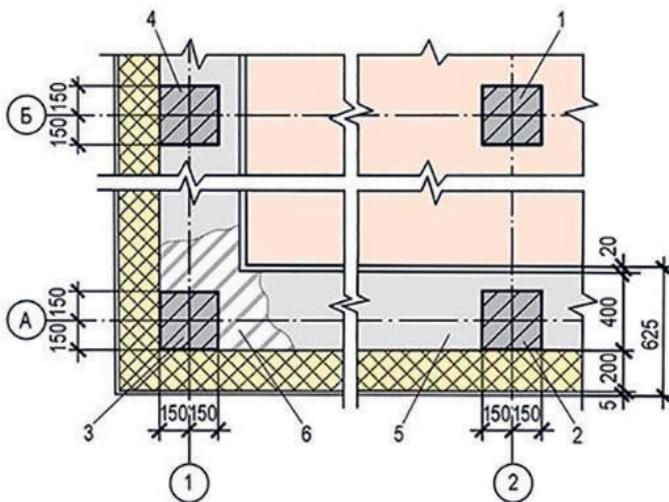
Фрагмент плана этажа малоэтажного гражданского здания с монолитным железобетонным каркасом и 2-слойными наружными стенами с эффективной теплоизоляцией; 1 – рядовая колонна среднего ряда; 2 – рядовая колонна крайнего ряда; 3 – торцевая колонна крайнего ряда; 4 – торцевая колонна среднего ряда; 5 и 6 – кладка из ячеистобетонных блоков, показанная для сравнения по-дизайнерски и по правилам строительного черчения
